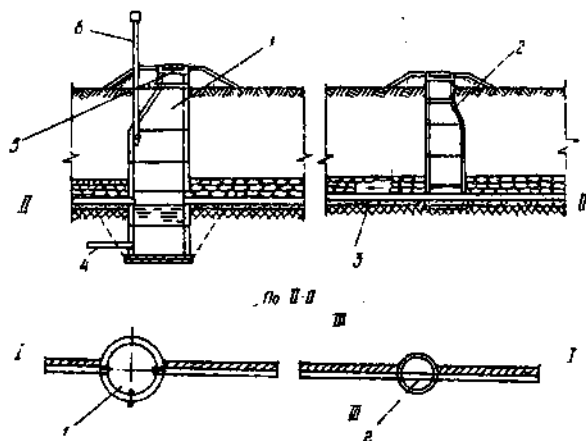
Бетонная труба и схема дренажа для сбора подземных вод
